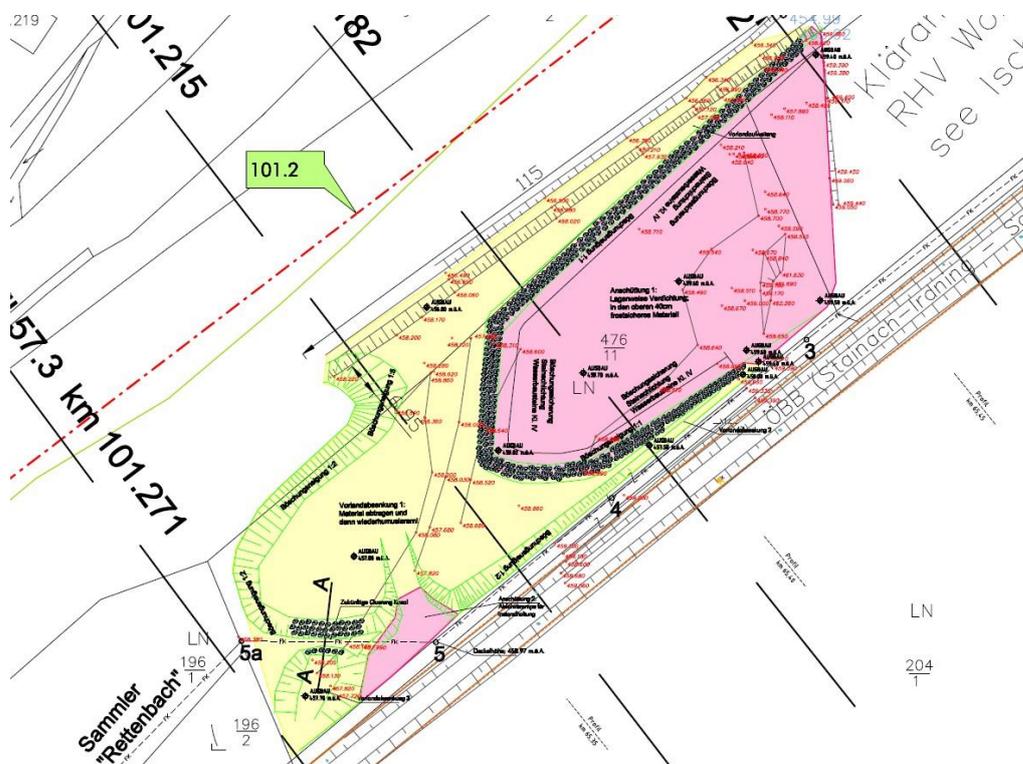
Lageplan zur Herstellung von Anschüttungen im Hochwasserabflussbereich der Oberen Traun – Stadtgemeinde Bad Ischl vom 06.04.2012, ZT-GmbH HIPI.
